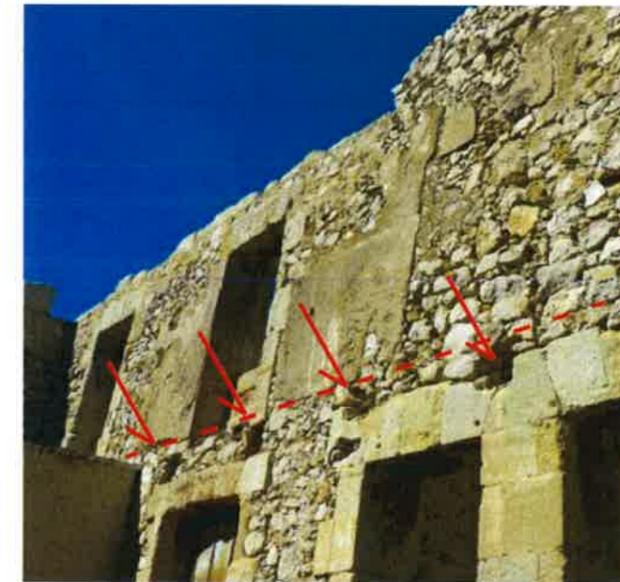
Traces des empochements des poutres du plancher intermédiaire
